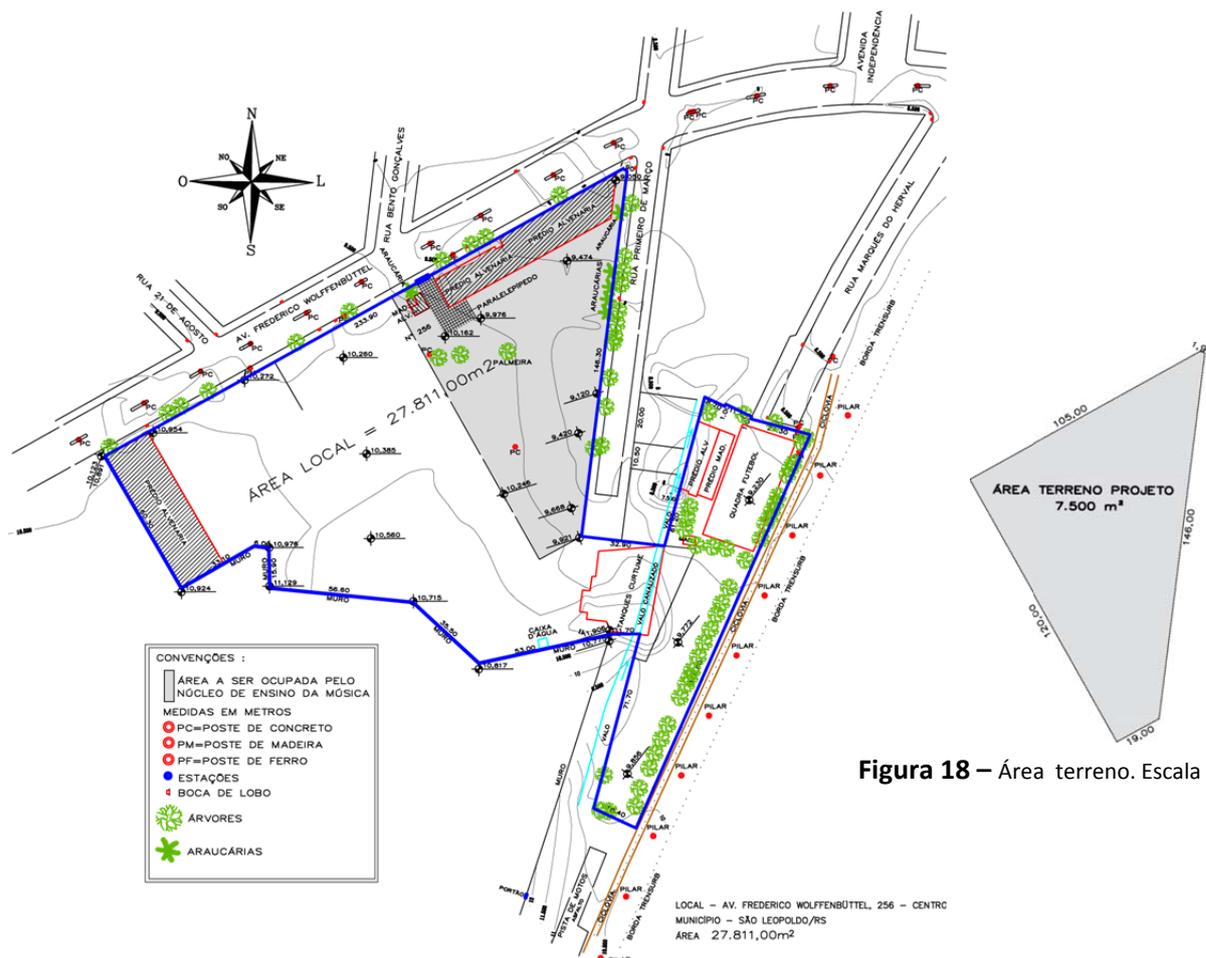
Levantamento Planialtimétrico. Escala 1/3000.
